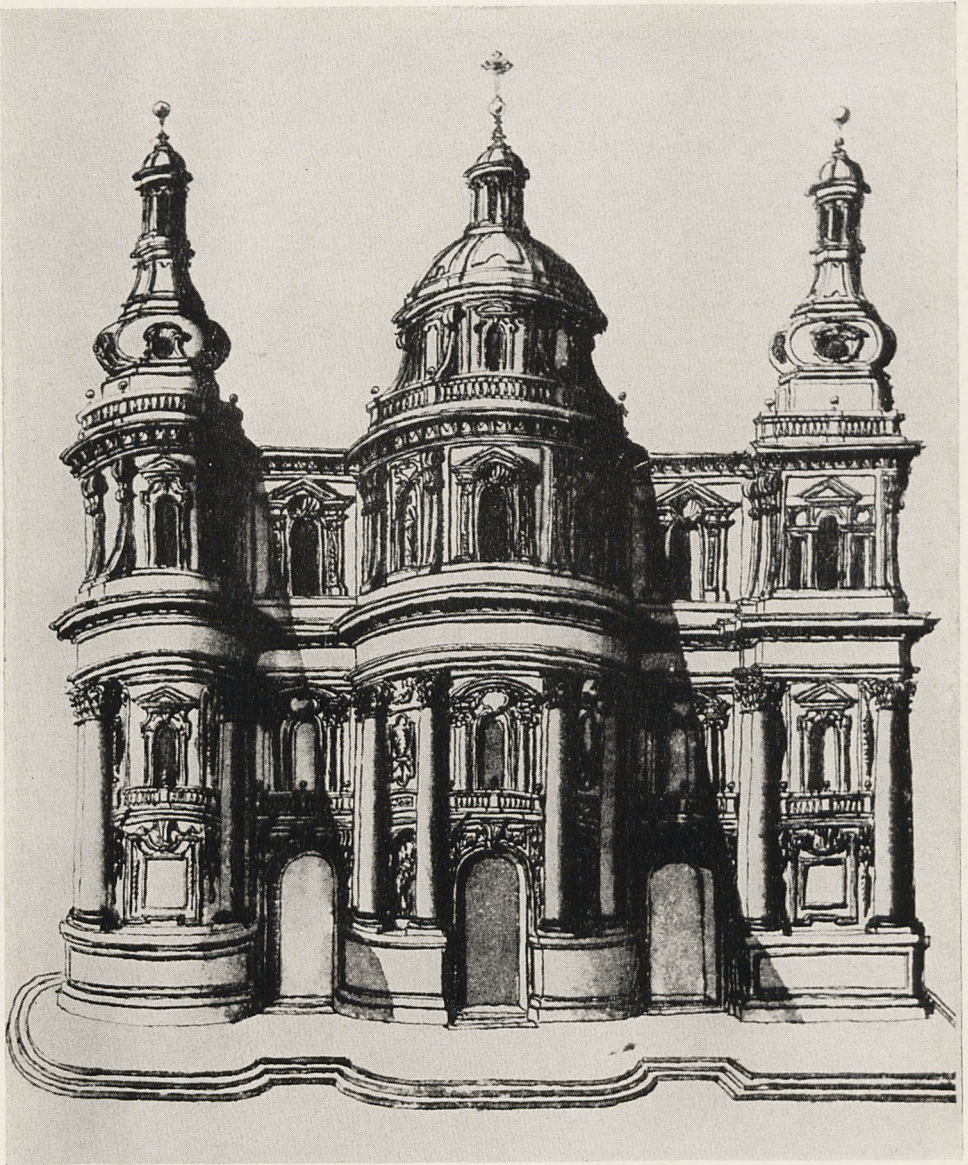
Idealentwurf für eine Kirchenfassade mit alternativem Vorschlag für die Türme. Mailand, Raccolta delle stampe di A. Bertarelli, Martinelli-Nachlaß, Band I, Fol 38.
